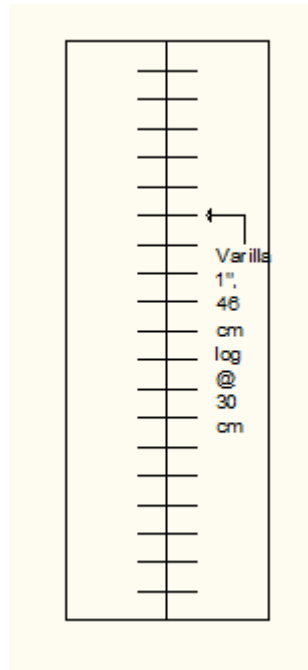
Juntas transversales para diseño de pavimento rígido.
